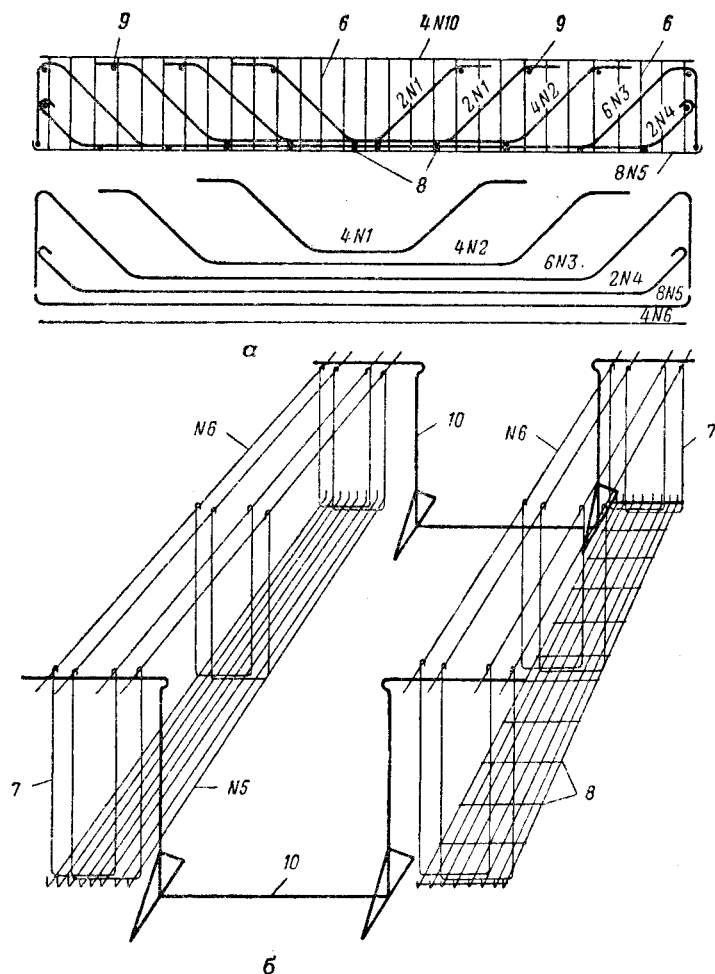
Схема сборки арматурного каркаса ребра железобетонного пролетного строения:
